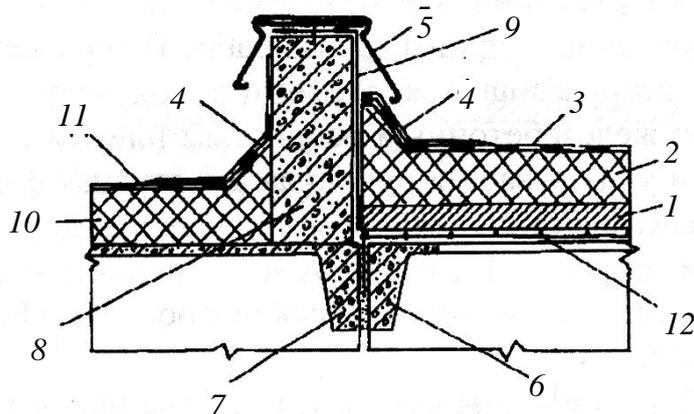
Схема устройства шва между невскрывающимся покрытием и вскрываемым легкобрасываемым покрытием при использовании железобетонных ребристых плит:
